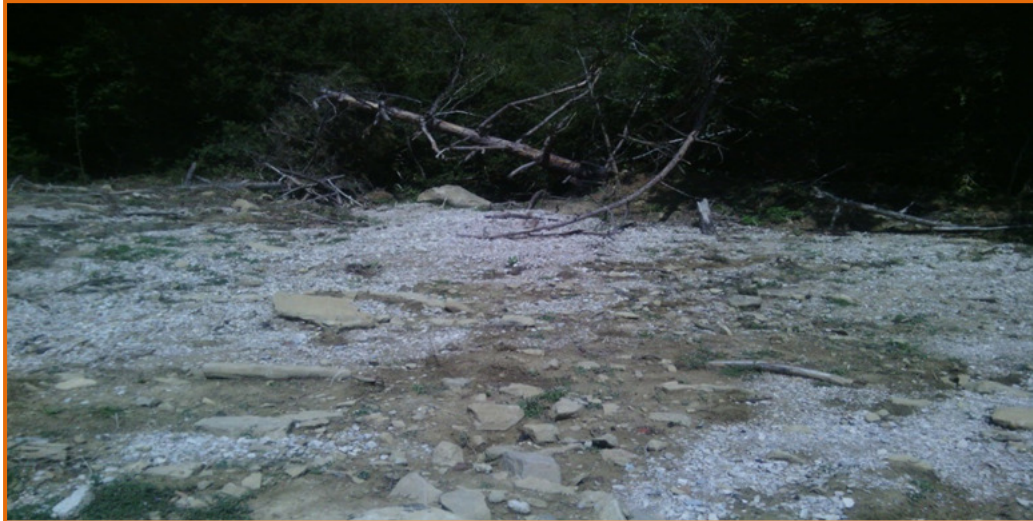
Detalle del estado actual de explanación minada y derrumbe de paños de hormigón
